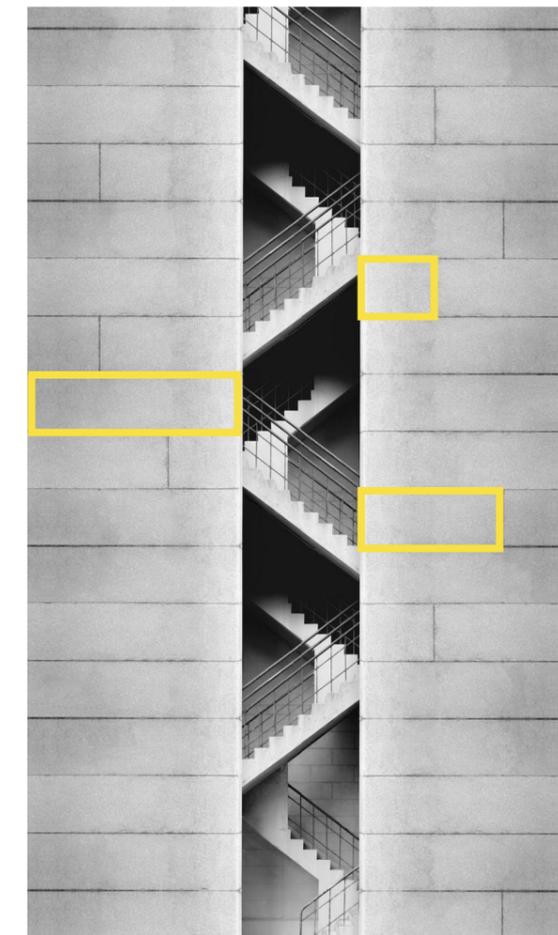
Construcción con prefabricados de hormigón. Fuente: (Henry & Co., s. f.)
